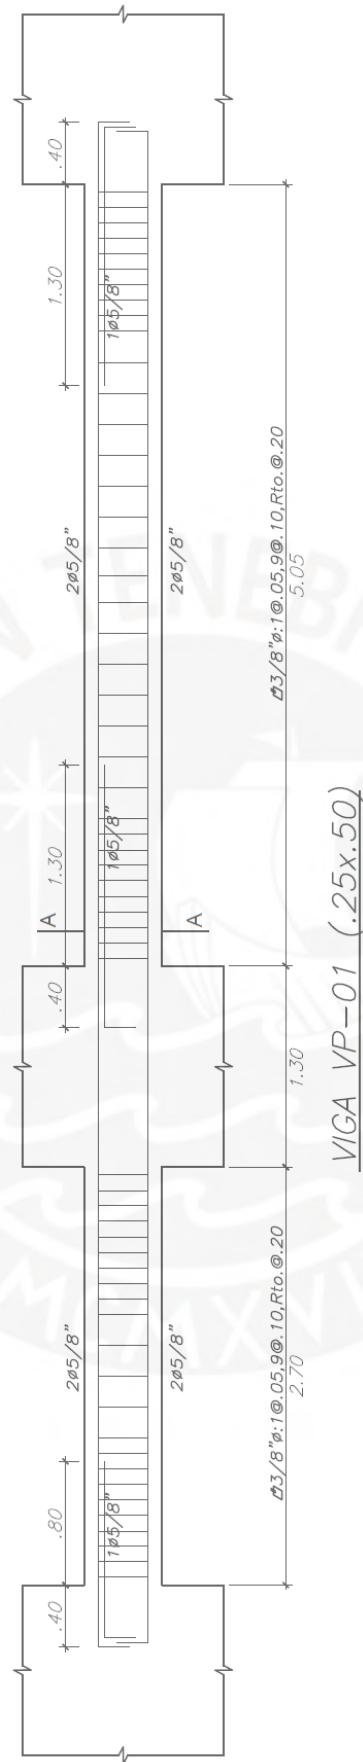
Refuerzo final de la viga VP-01 con ganchos estándar
